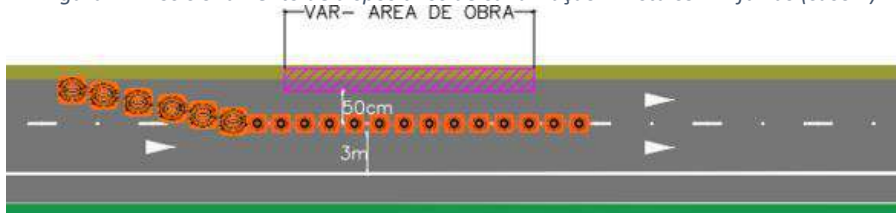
Posicionamento de dispositivos de canalização – Pista com 3 faixas (caso 1)
